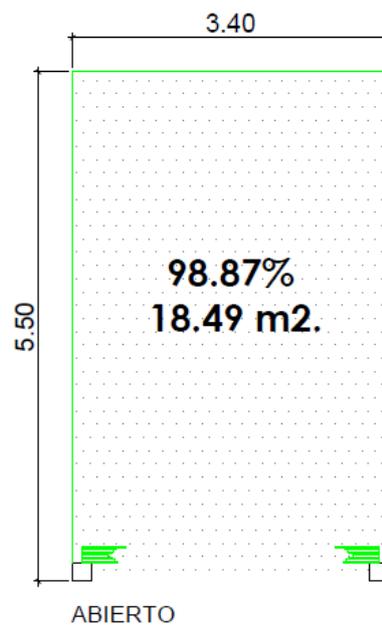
Vista en planta de la superficie del garaje puerta abierta.
